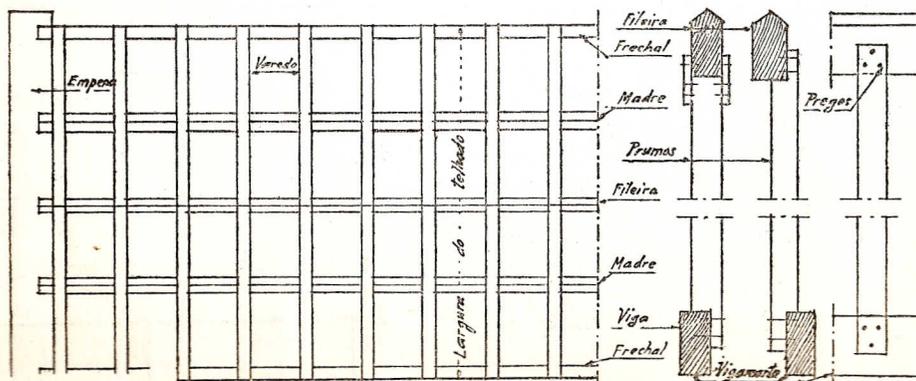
PLANTA DE UM MADEIRAMENTO DE DUAS ÁGUAS
